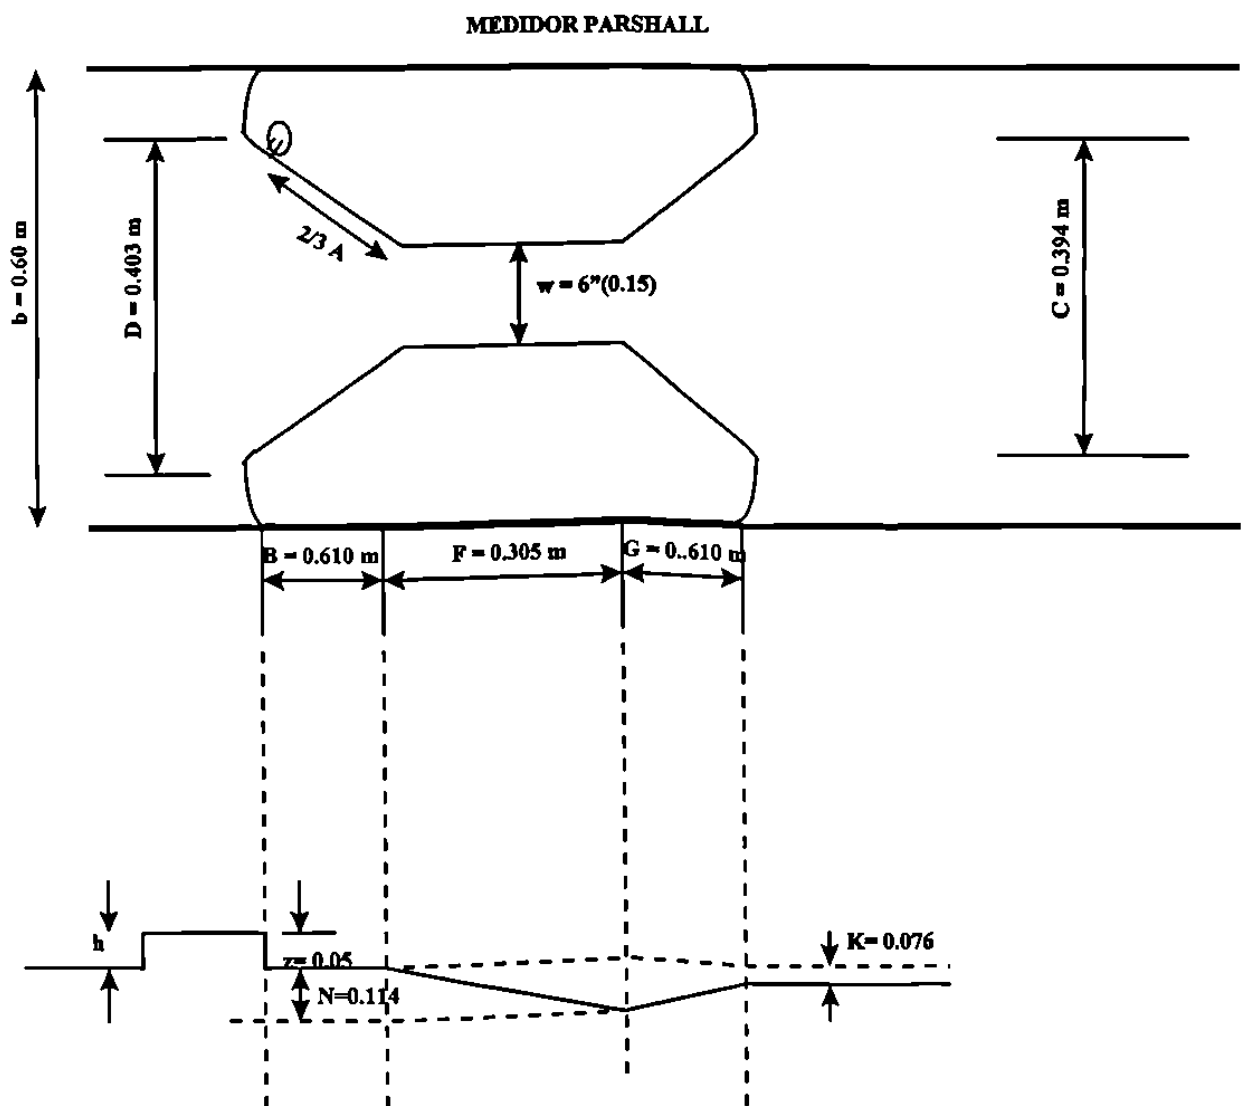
Planta y Elevación del Medidor Parshall, dimensionadas.
